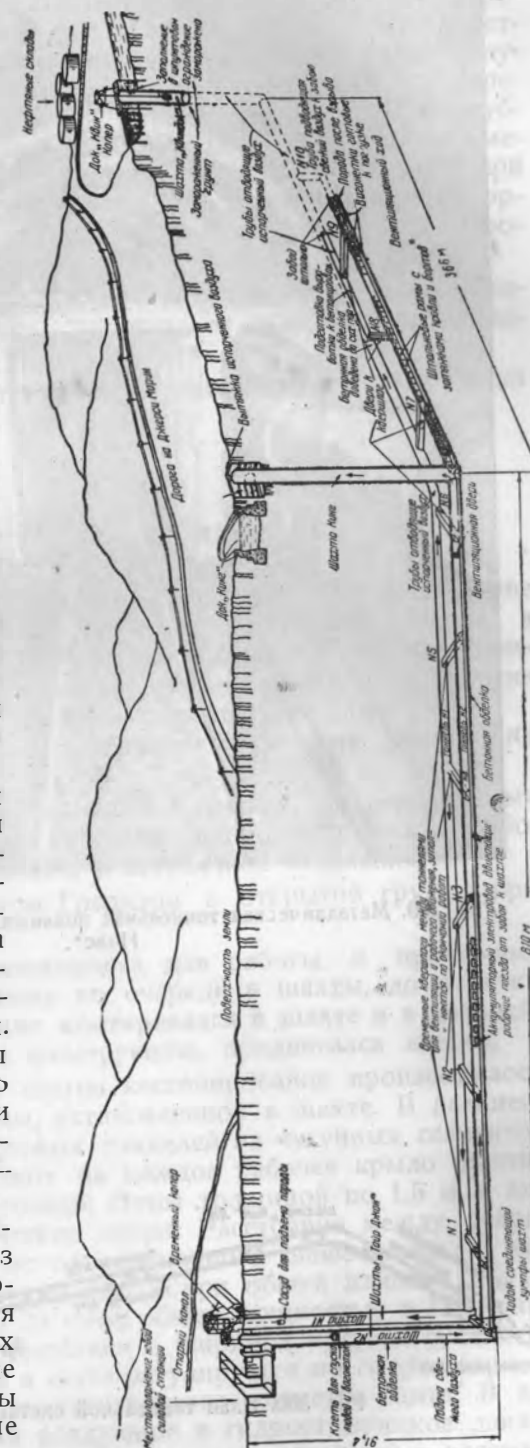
Схема тоннельной системы «Свенси» с показанием шахт и вентиляционных штреков.
